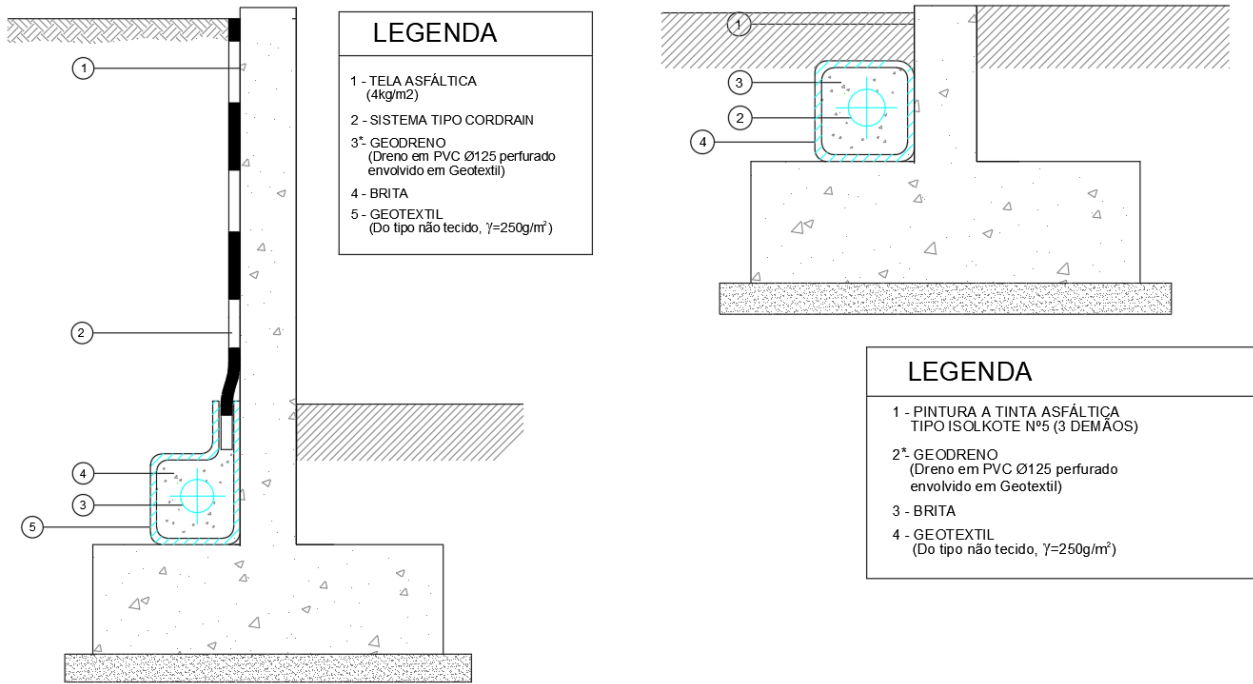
Pormenor Tipo de Impermeabilização e Drenagem (Projeto de estruturas).
